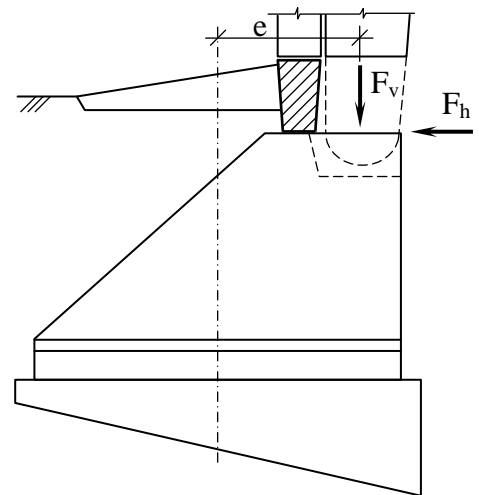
Позацентрове навантаження фундаменту під тришарнірну раму
